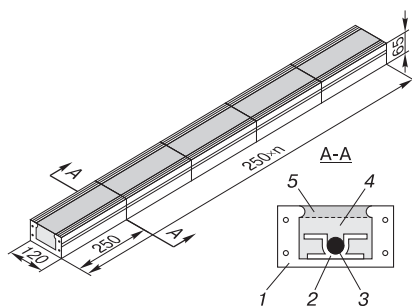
Вид керамобетонной перемычки. 1 – П-образный камень; 2 – фиксатор для укладки арматуры; 3 – арматура; 4 – бетон; 5 – защитный слой бетона
